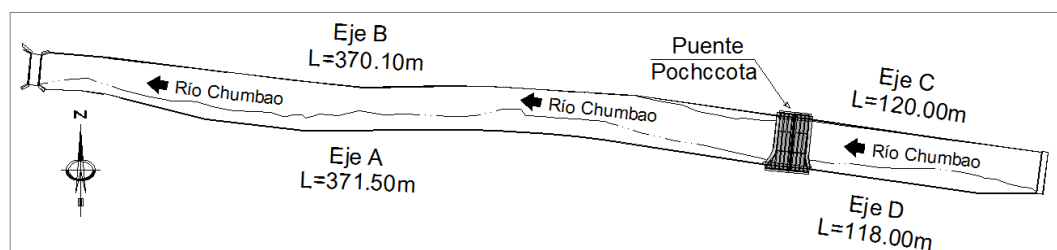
Vista en planta del puente Pochccota, ubicación de los muros de encauzamiento y protección sobre el río Chumbao.
